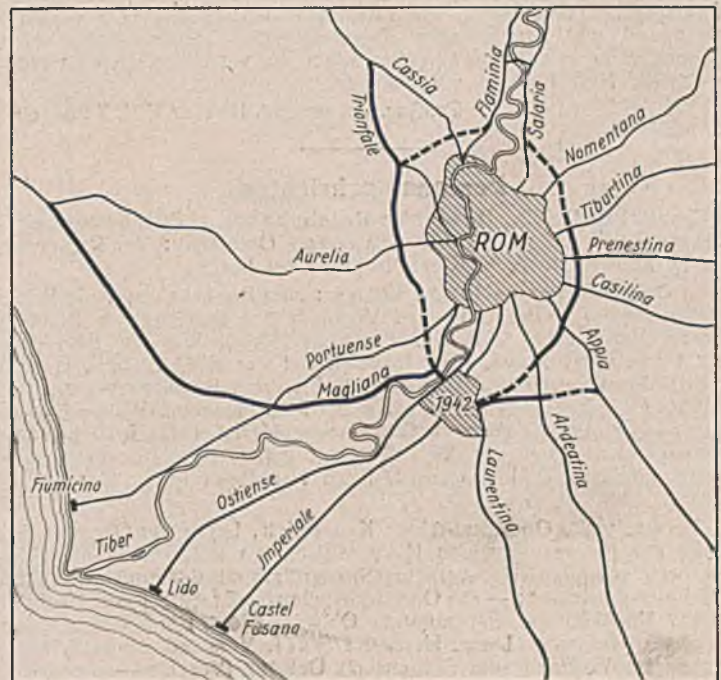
Plan mit zwei halbringförmigen Auffangstraßen.
